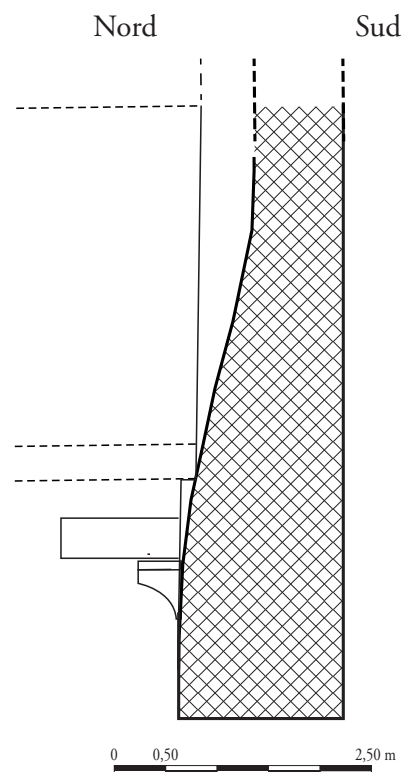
Profil du conduit de cheminée UM1-5-UC2
